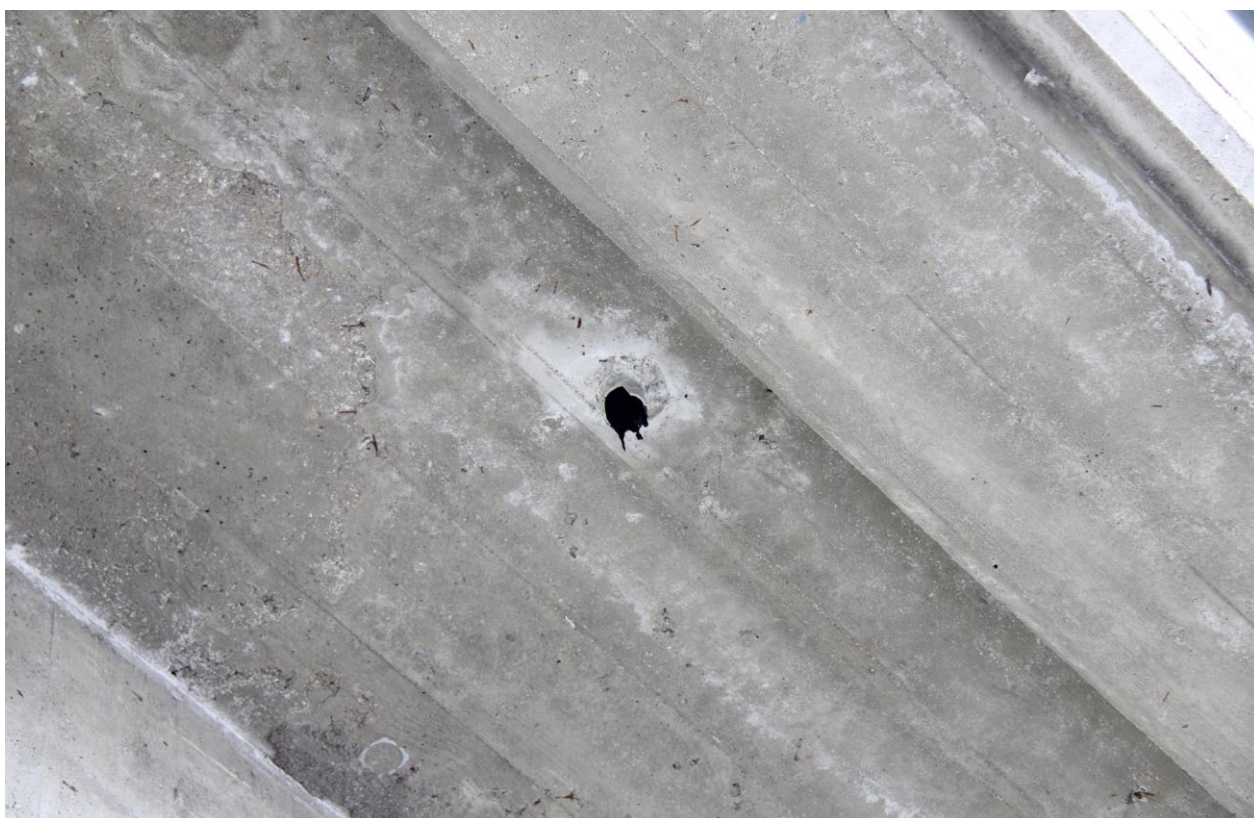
Detalj betongöverbyggnad vid mellanstöd. Betongytan i genomgående gott skick.
